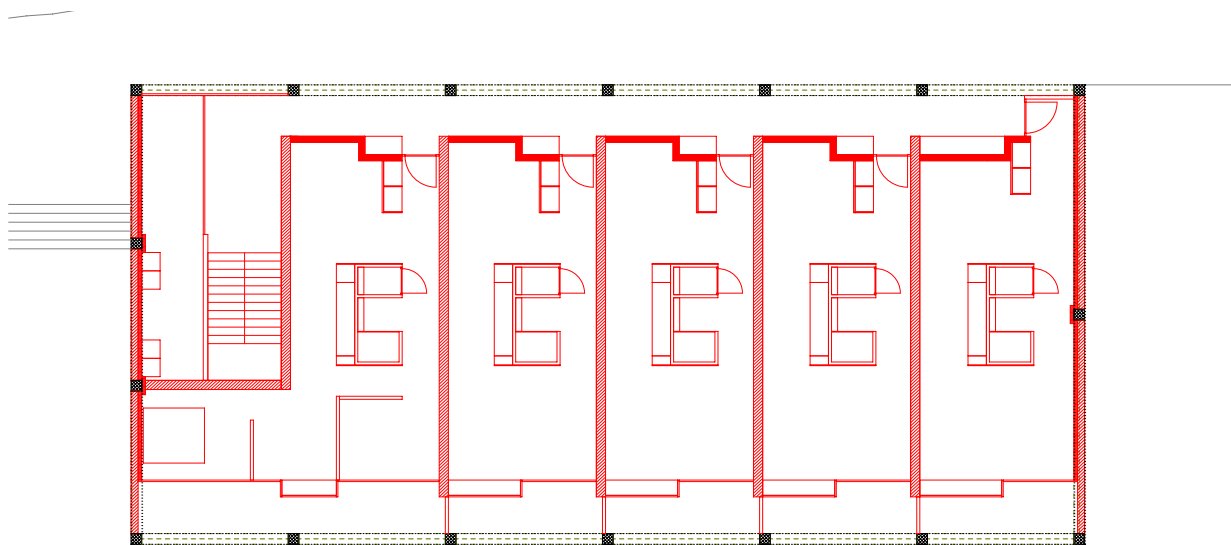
Grundriss 1. Obergeschoss, TK 11 am 21.12.2023
